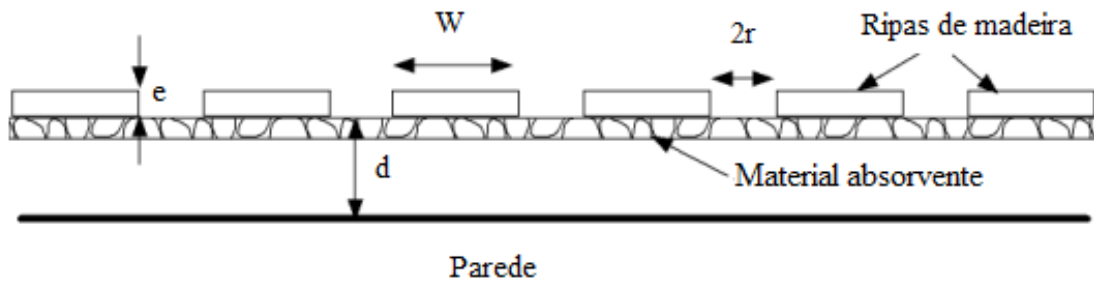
Esquema de painéis com ranhuras [Adaptado de 7]
